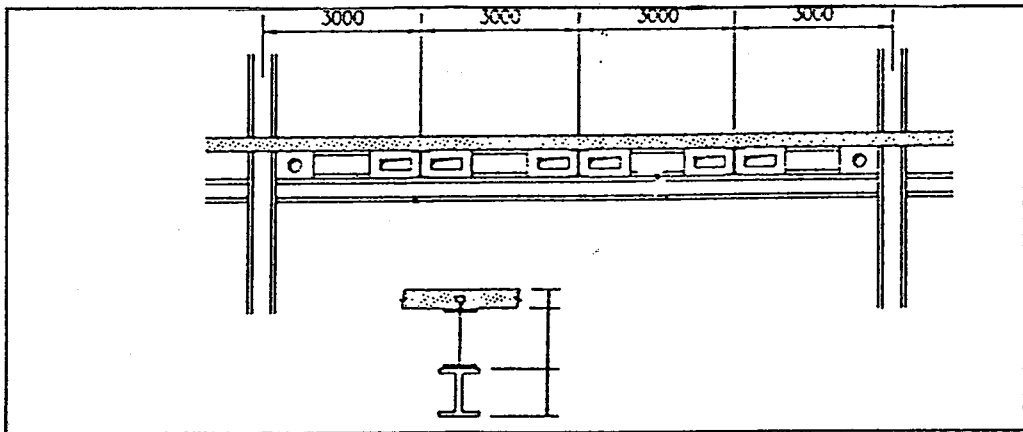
Normal donatılı prefabrike betonarme döşeme
